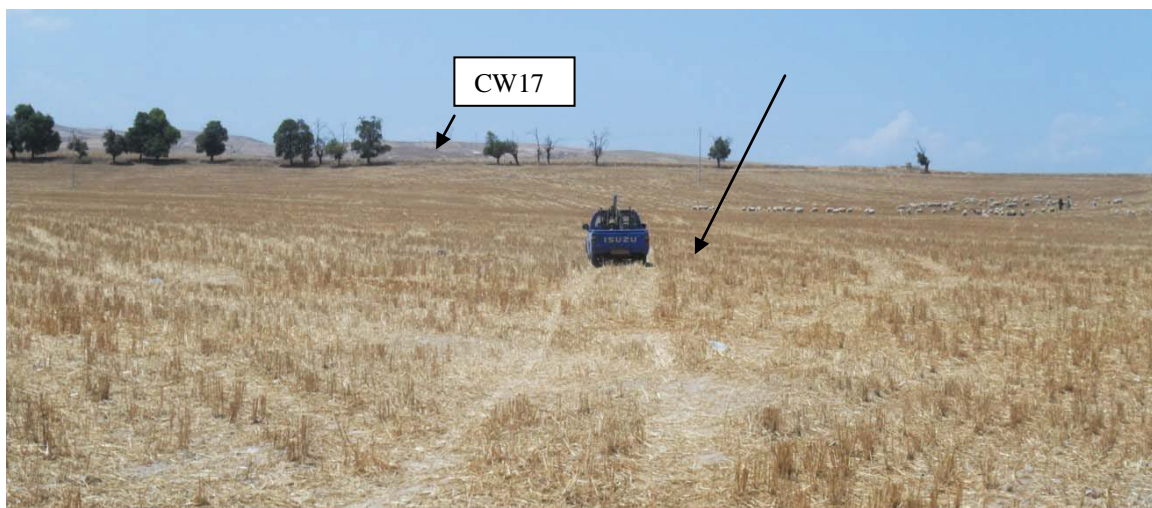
Site d'implantation de la station de pompage d'Oued Seguin
